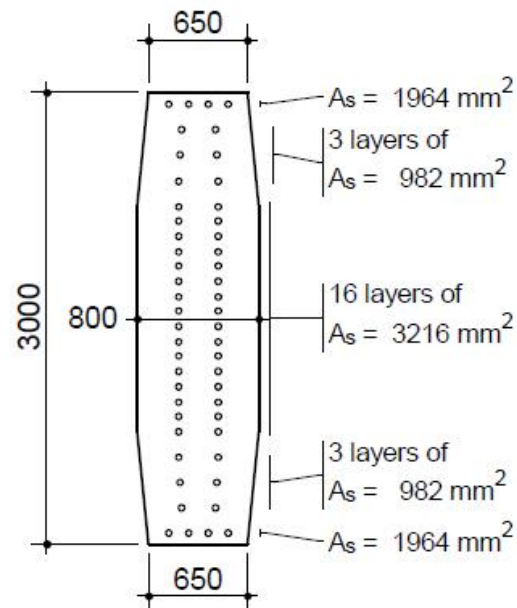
Esquematização da armadura considerada na análise transversal do pilar
